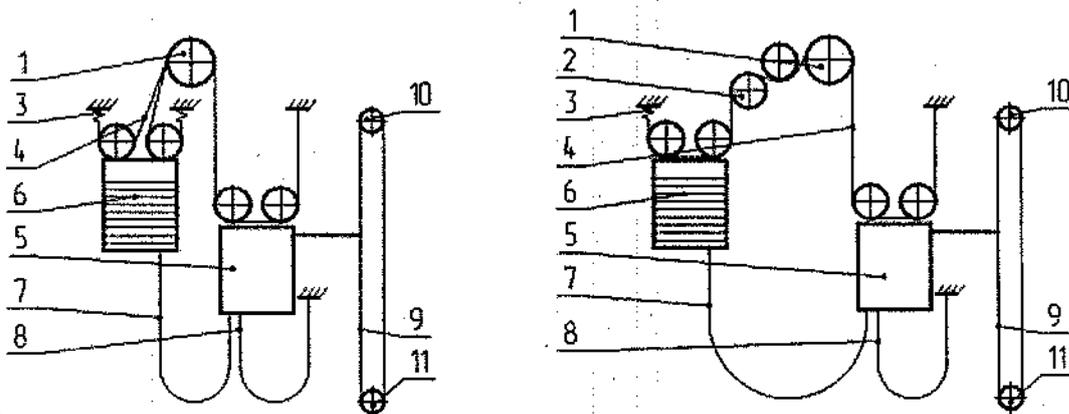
Кинематическая схема лифта а) для лифтов с боковым расположением противовеса б) для лифтов с задним расположением противовеса: 1 - Шкив канатоведущий; 2 - отбойный блок; 3 - подвеска пружинная; 4 - канат тяговый; 5 - кабина; 6 - противовес; 7 - цепь компенсирующая, при $H > 45$ м; 8 - кабель подвесной; 9 - канат ограничителя скорости; 10 - ограничитель скорости; 11 - натяжное устройство.
